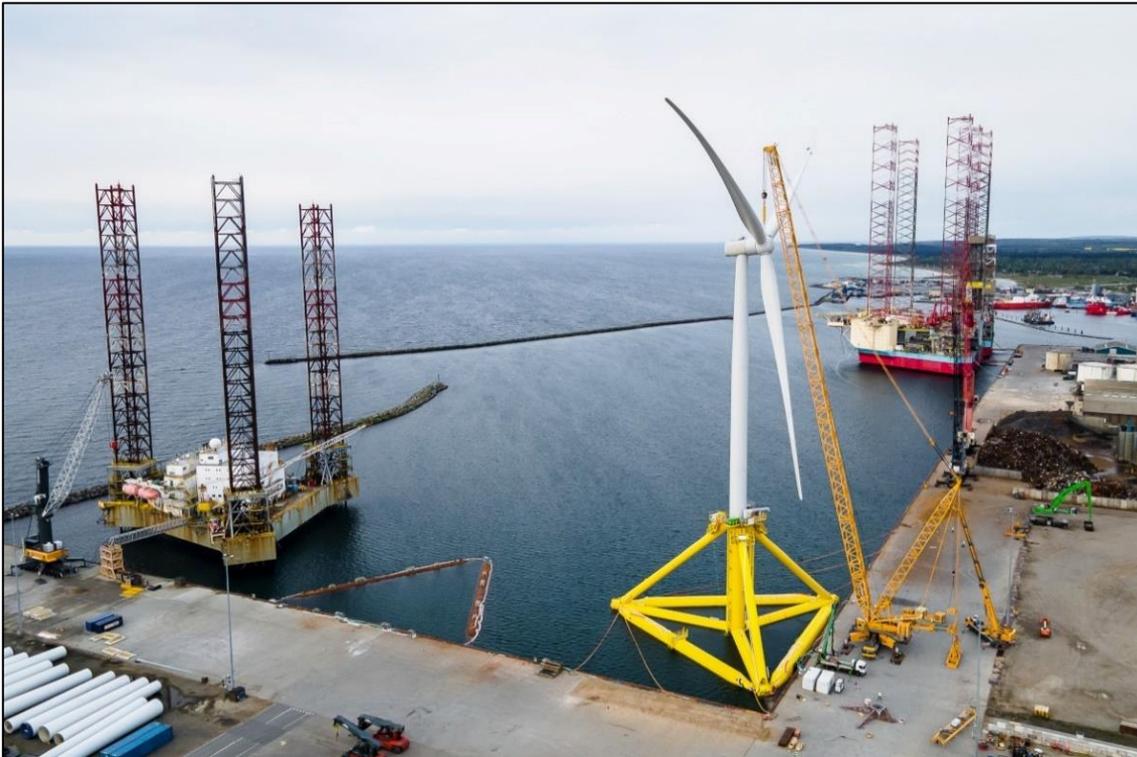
Assemblaggio della turbina Siemens Gamesa da 3.6 MW sulla fondazione galleggiante *TetraSpar
